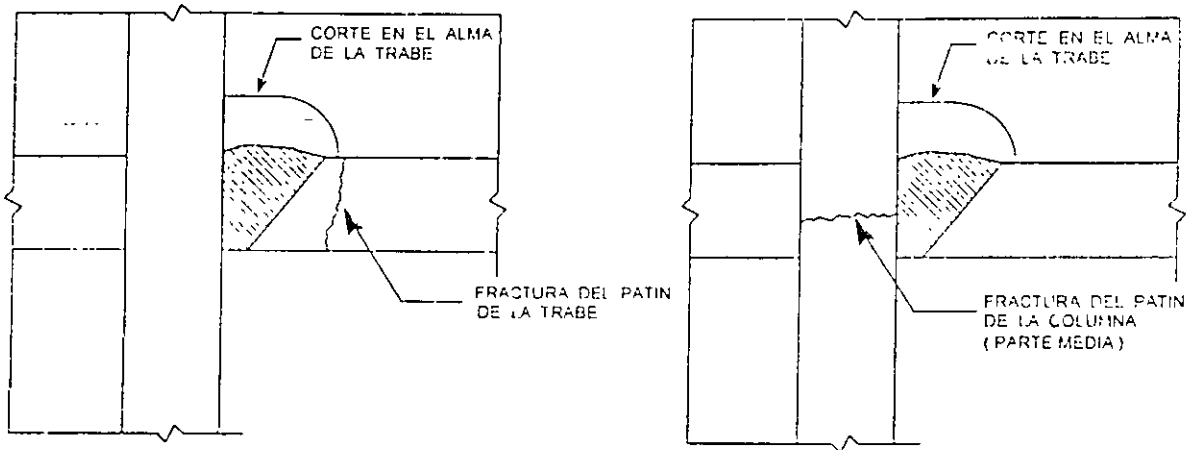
Fractura en el patín de la trabe en la zona próxima a la soldadura y fractura en la parte media del patín de la columna.
